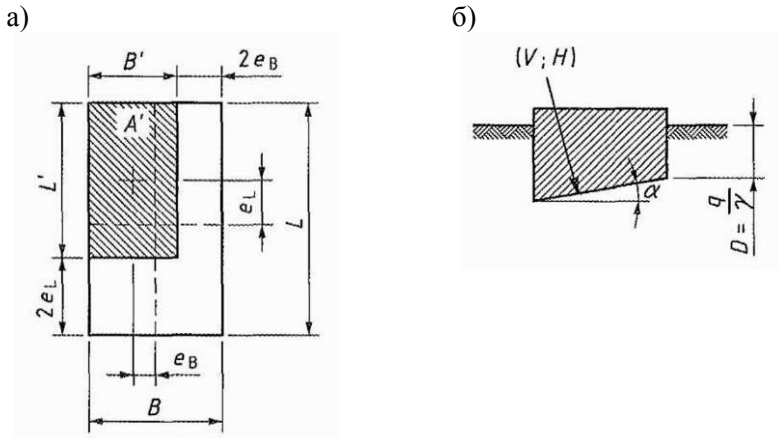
Условные обозначения величин, применяемых при определении несущей способности грунта в соответствии с ТКП EN (а — план подошвы фундамента, б — разрез).
